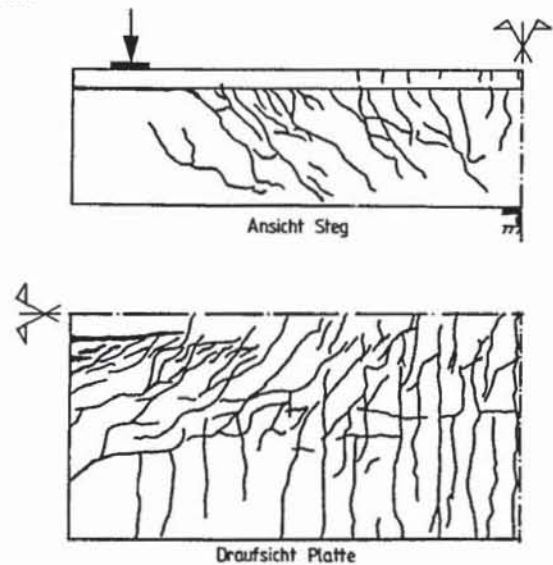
Rißbild eines Plattenbalkens im Bereich des querträgerfreien Endes bei Lasteinleitung über den Steg und ausgelagerter Biegezugbewehrung kurz vor dem Bruch (nach [33])
